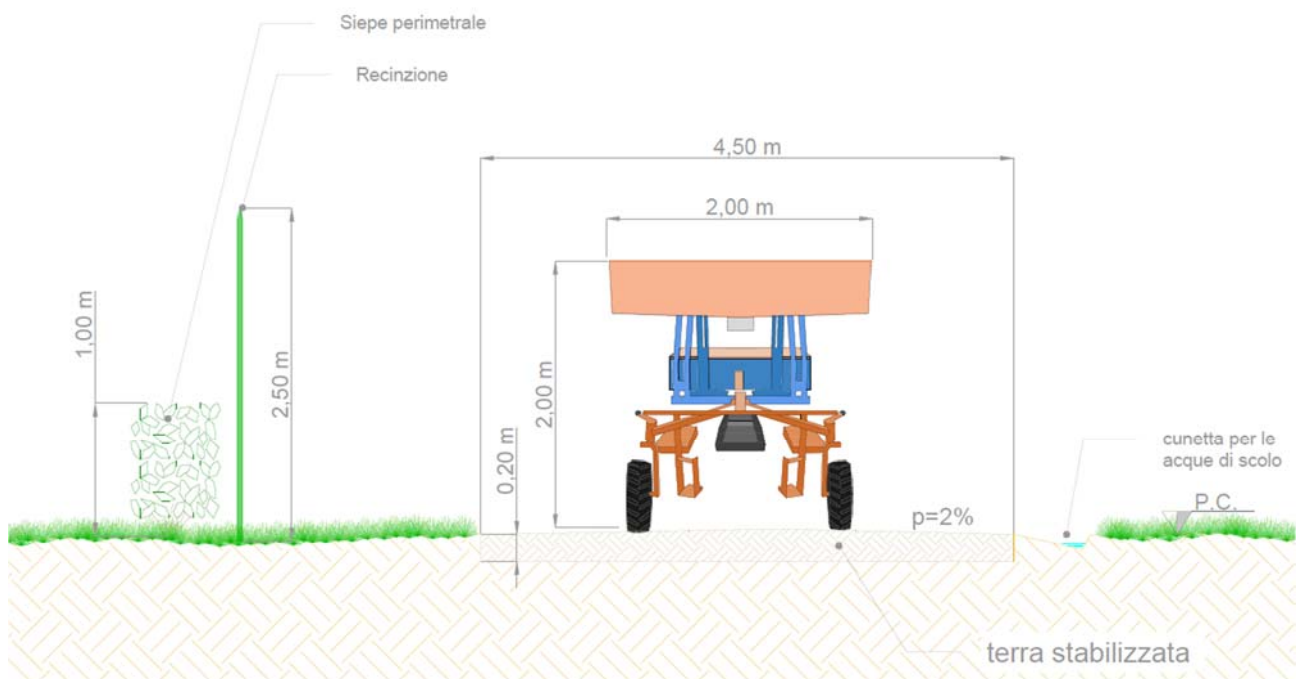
Dettaglio costruttivo delle strade per la viabilità interna al sito di installazione dell'impianto fotovoltaico
